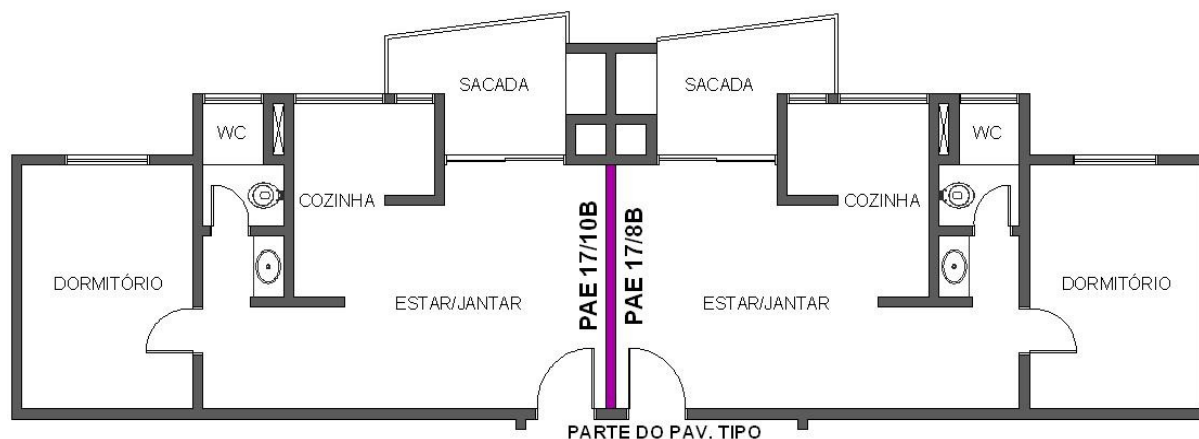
Planta Baixa esquemática parcial do edifício B com a localização das paredes ensaiadas.
